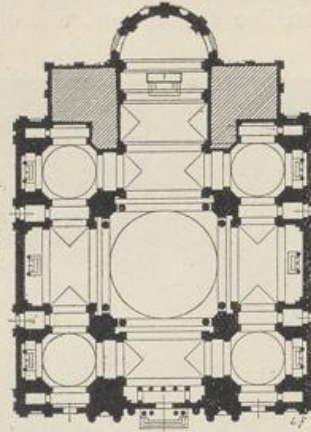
Grundriss des Duomo nuovo zu Brescia
